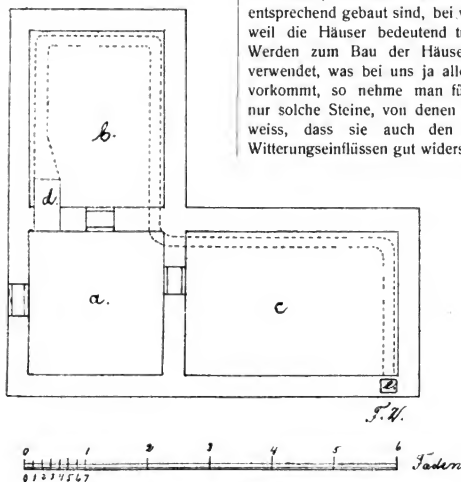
Fig. II. Grundriss einer einfachen Treibhausanlage.
